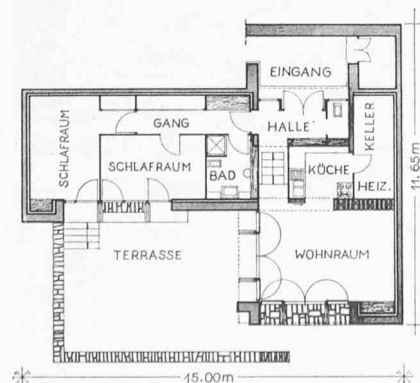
Grundriss 1:300 eines Dreizimmerhauses mit 103 m² Grundfläche wie es in der Gesellschaft pauschal für rd. 150 000 NF einschliesslich Grundstück angeboten wird
